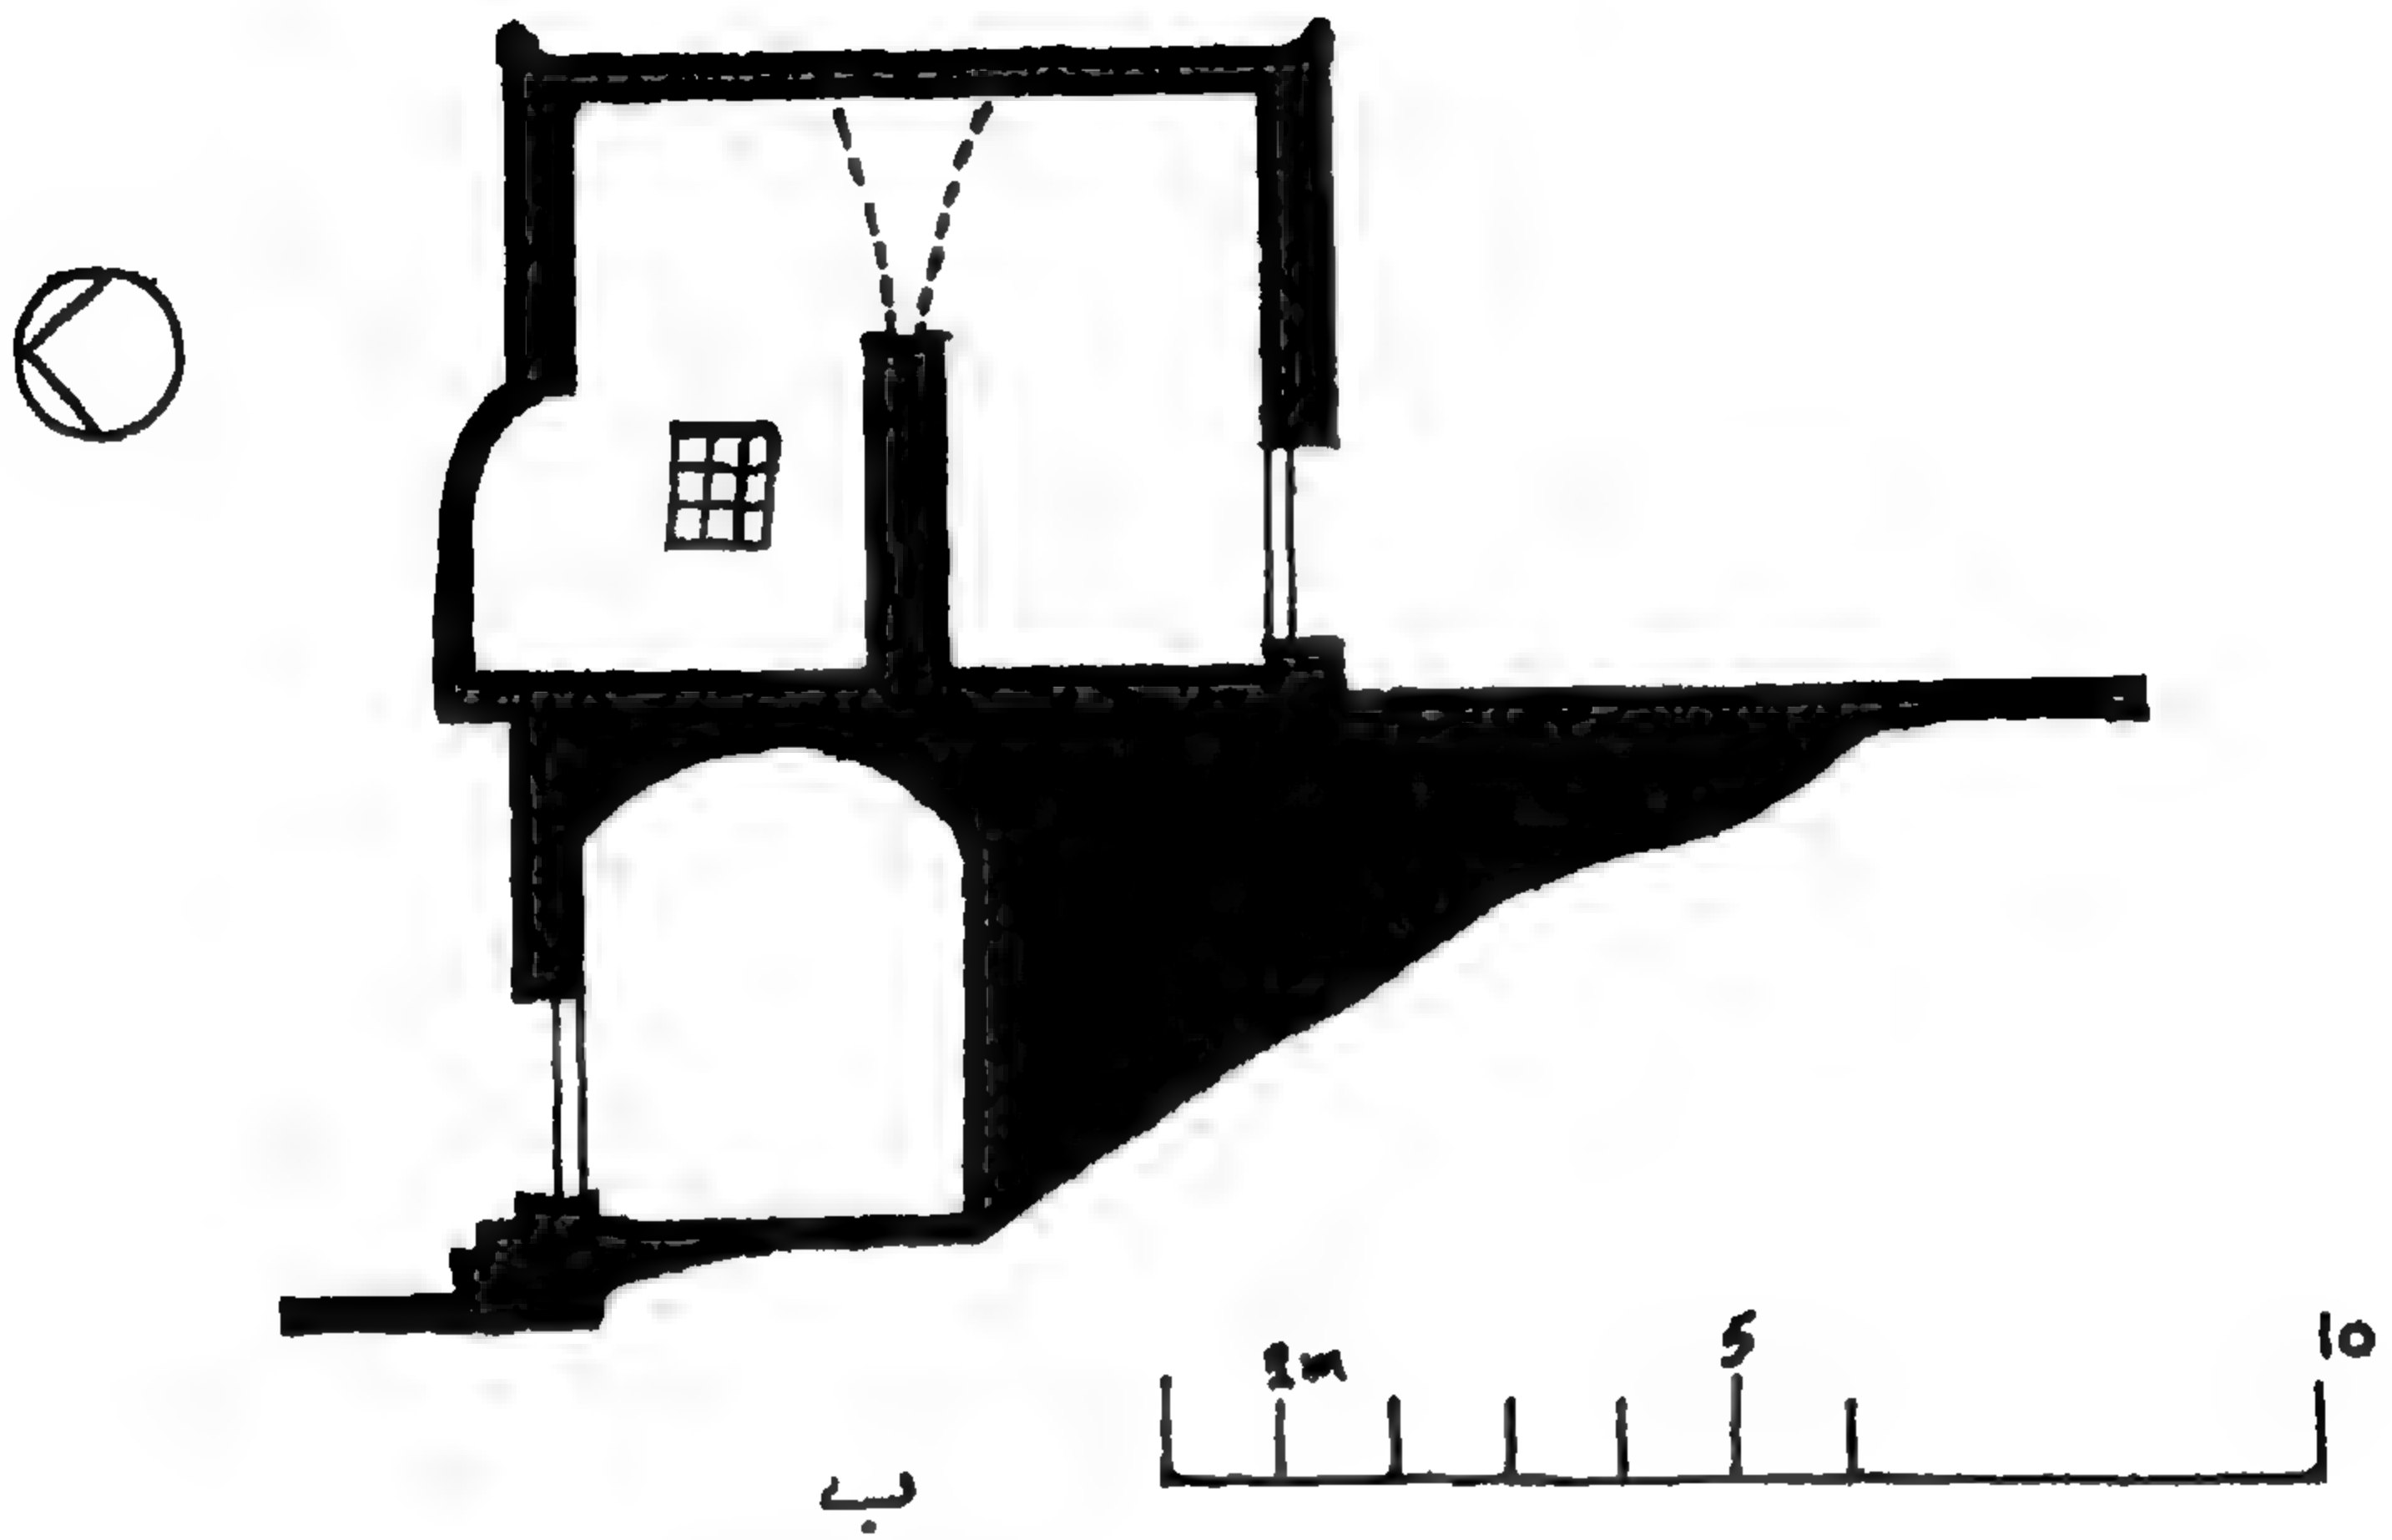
مسقط أفقي للمدرسة الياقوتية برباط البريهي بمدينة
